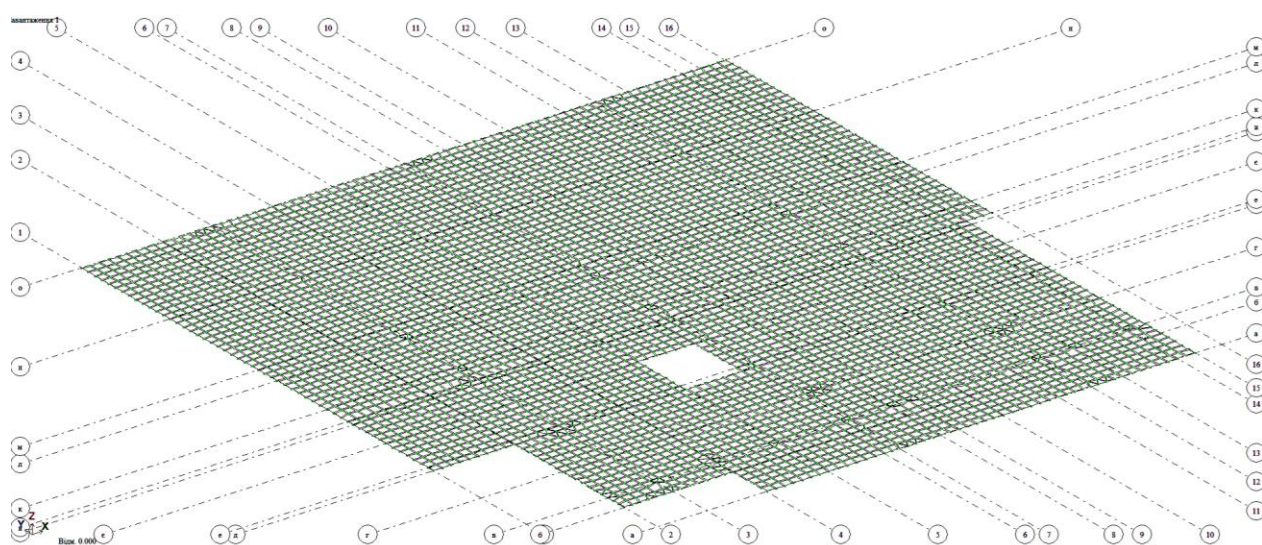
Пластинчасті елементи плити перекриття над підвальним поверхом
